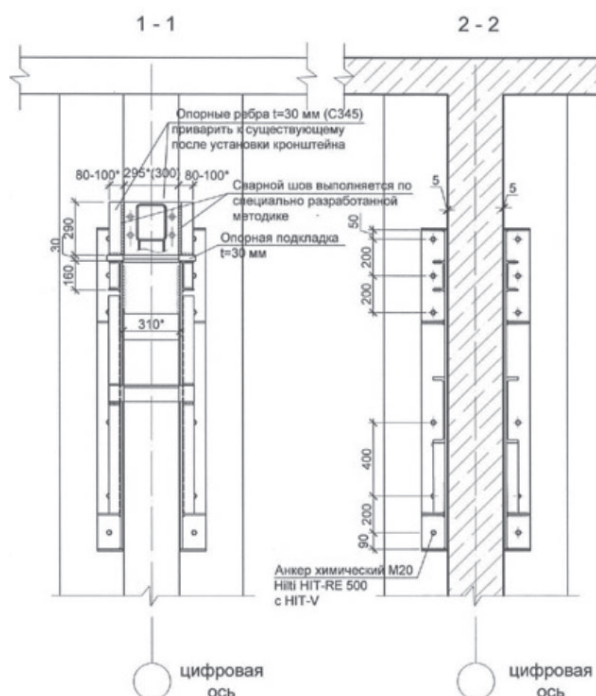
Конструкция усиления коротких железобетонных консолей в составе пилонов (разрезы 1-1 и 2-2)
